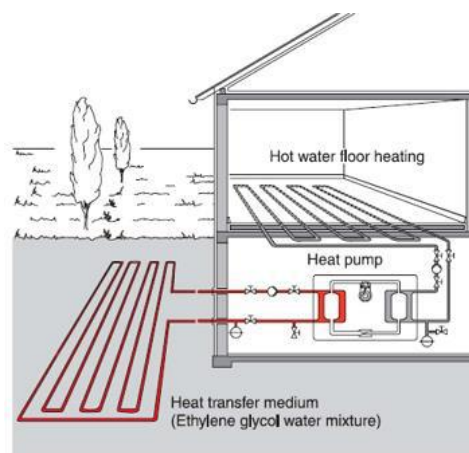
Esempio di installazione sonde geotermiche orizzontali².
